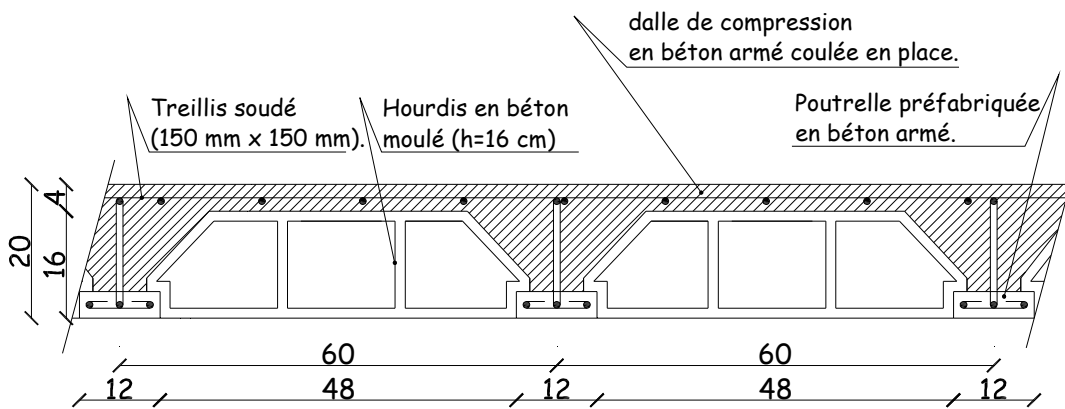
Plancher en béton armé avec poutrelles et hourdis (Plancher semi-préfabriqué)
